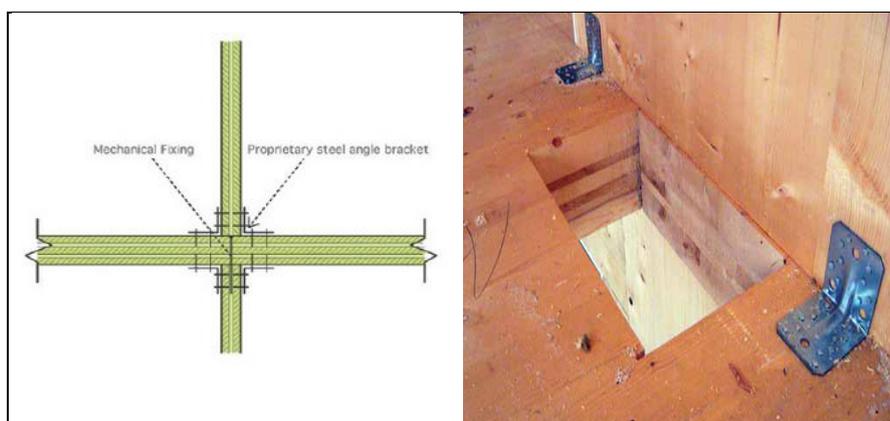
Detalhe das ligações metálicas entre as placas CLT (LIDDELL, 2013)
